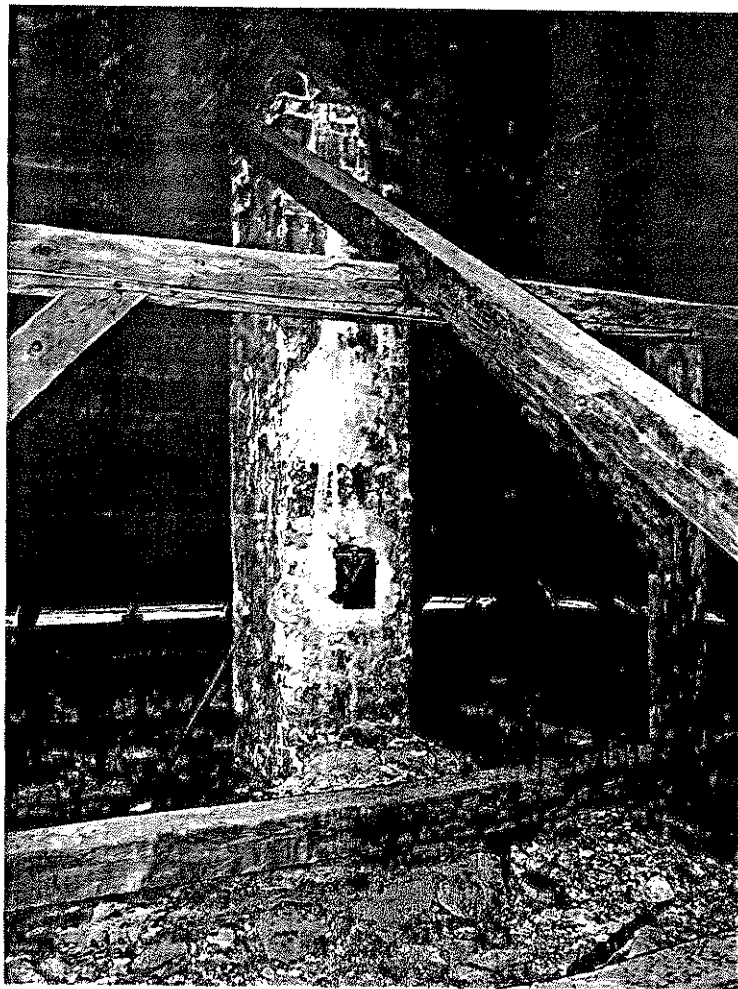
Więźba dachowa z dodatkowymi zastrzałami kosza.
